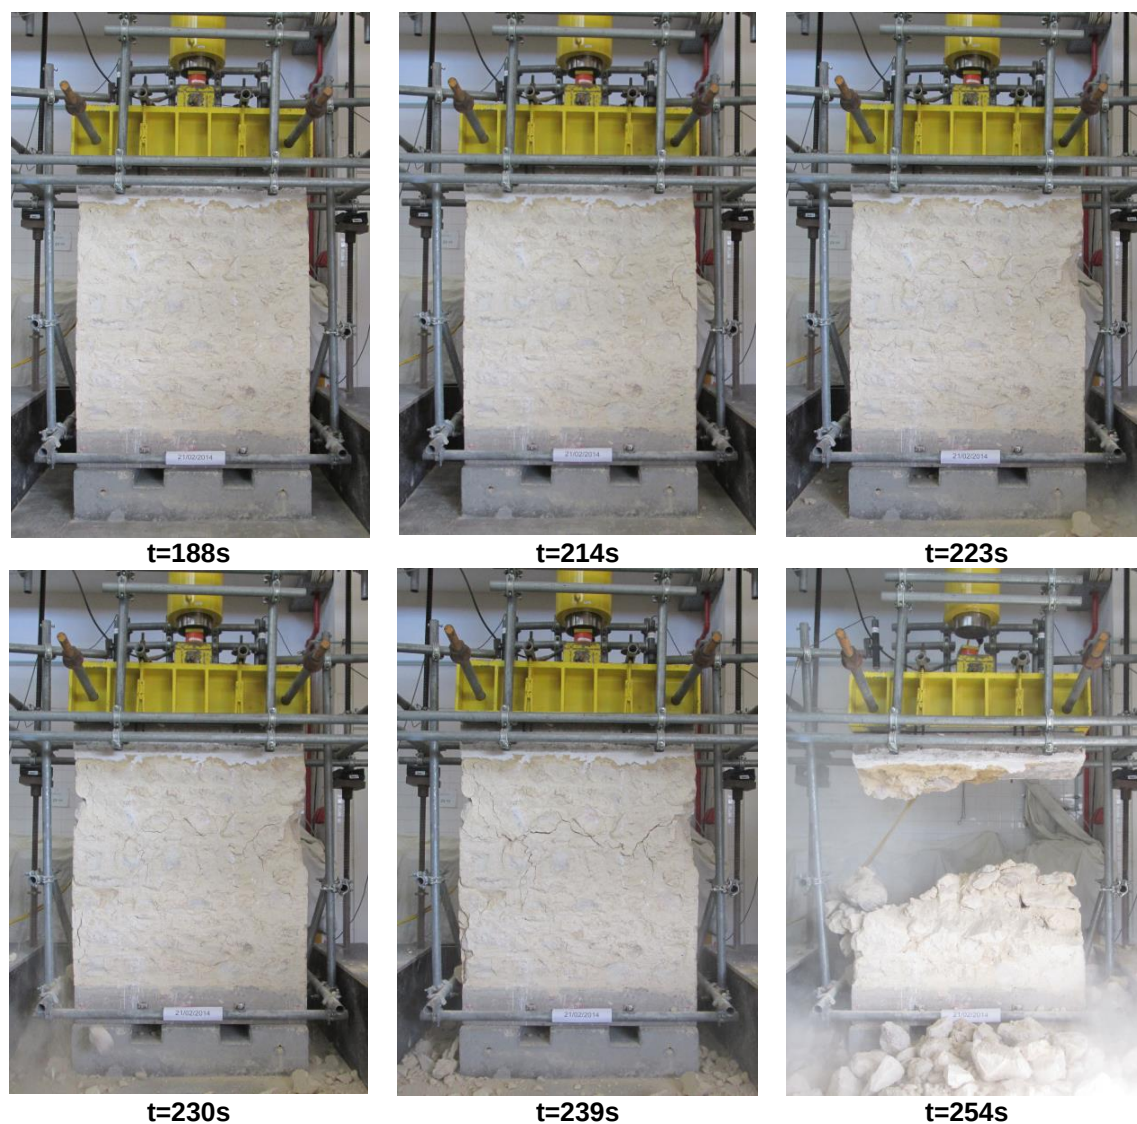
Ensaio de compressão axial sobre o murete m16.
